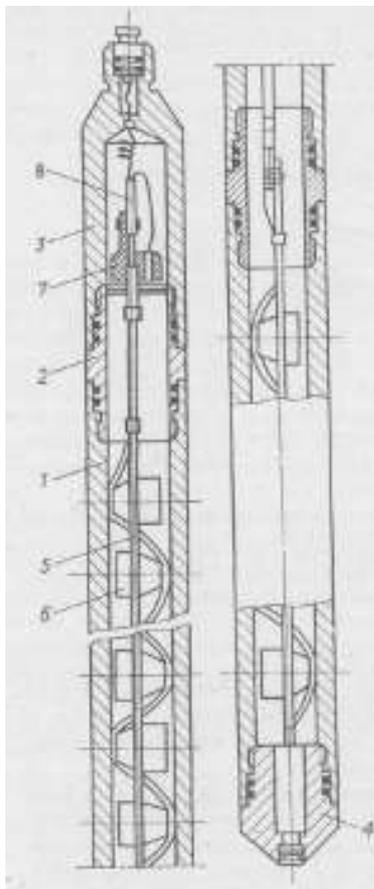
Схема корпусного одноразового перфоратора ПКТ-89-Н
